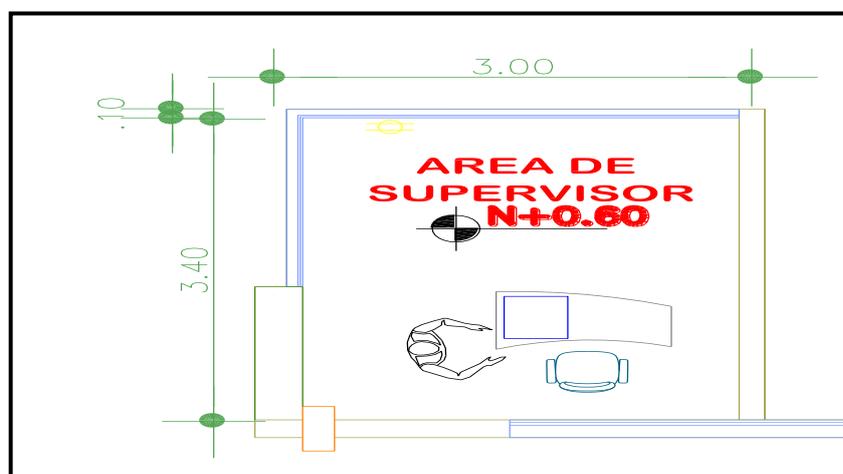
Vista arquitectónica específica del área de supervisión de la planta de reciclaje
